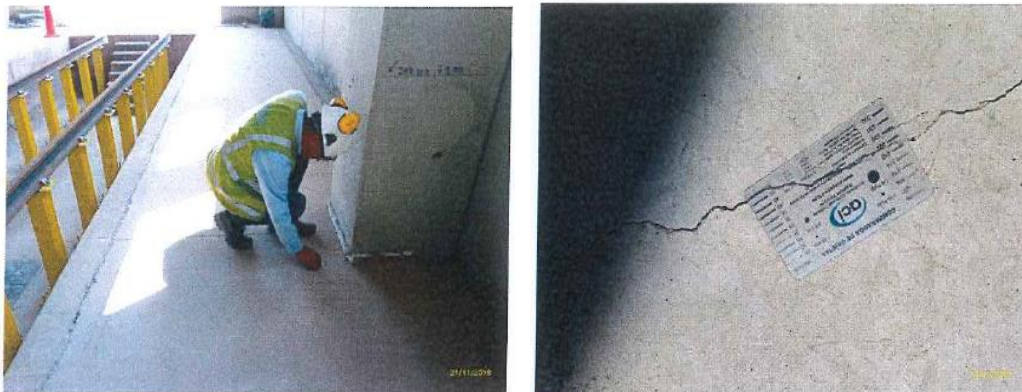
Control de fisuras presentadas en las losas
